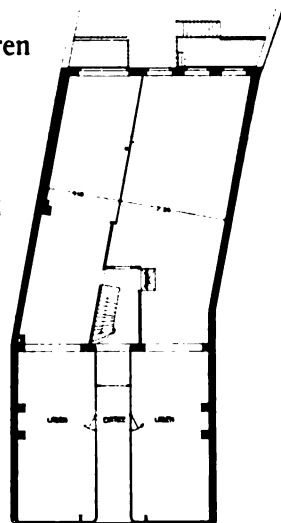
Schadowstrasse 34. Erdgeschoss.
